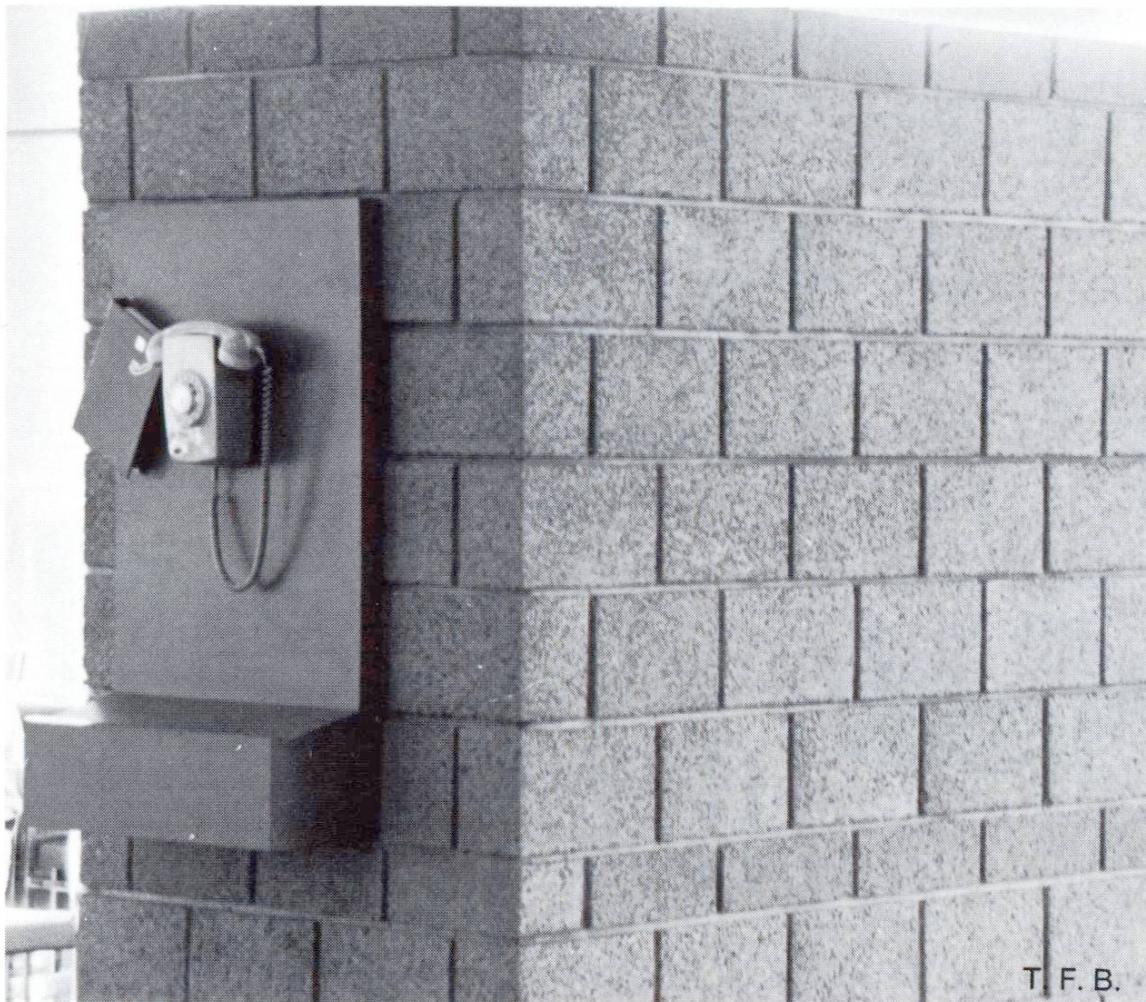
Sichtmauerwerk mit Betonsteinen zur lockeren Raumteilung.
